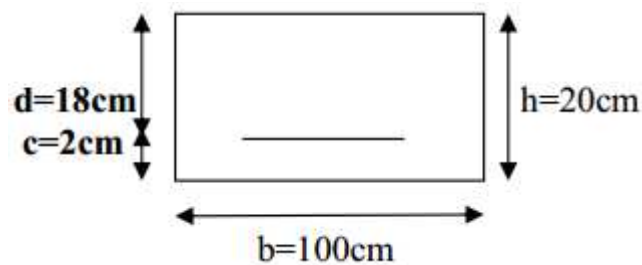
section à considérer pour le ferrailage du mur plaque.
